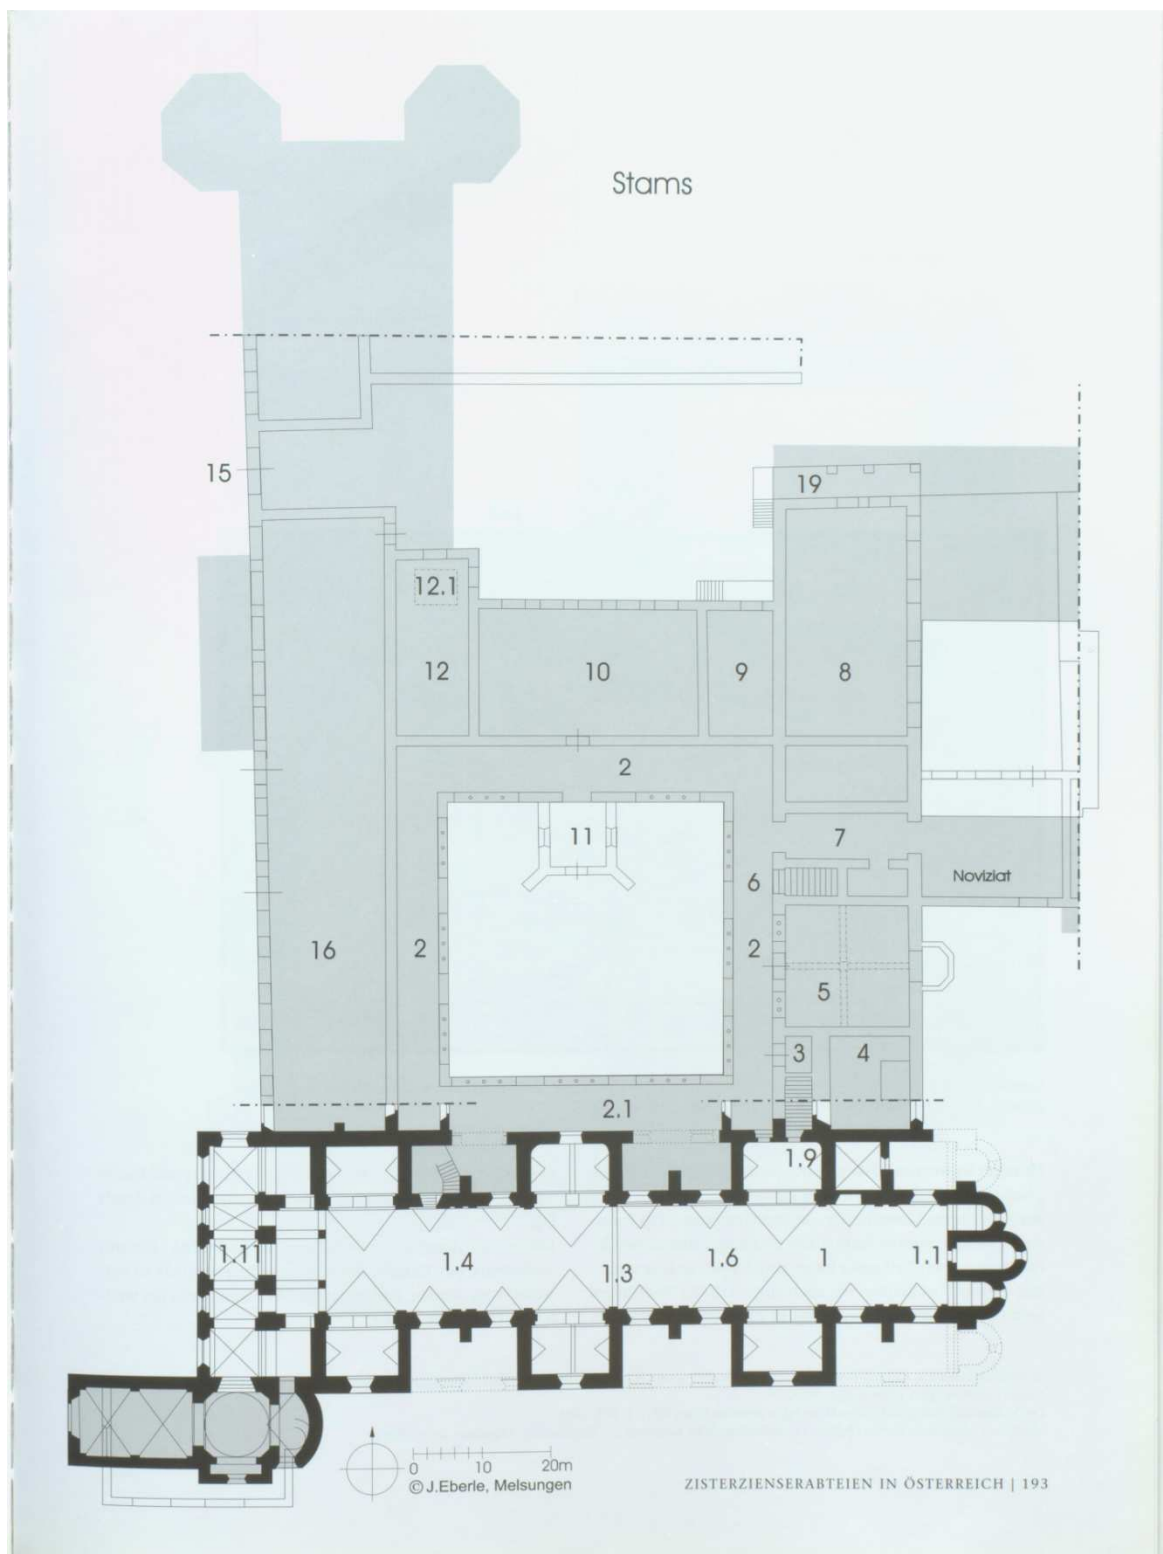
Stift Stams, Rekonstruktion des mittelalterlichen Grundrisses, Jürgen Eberle
